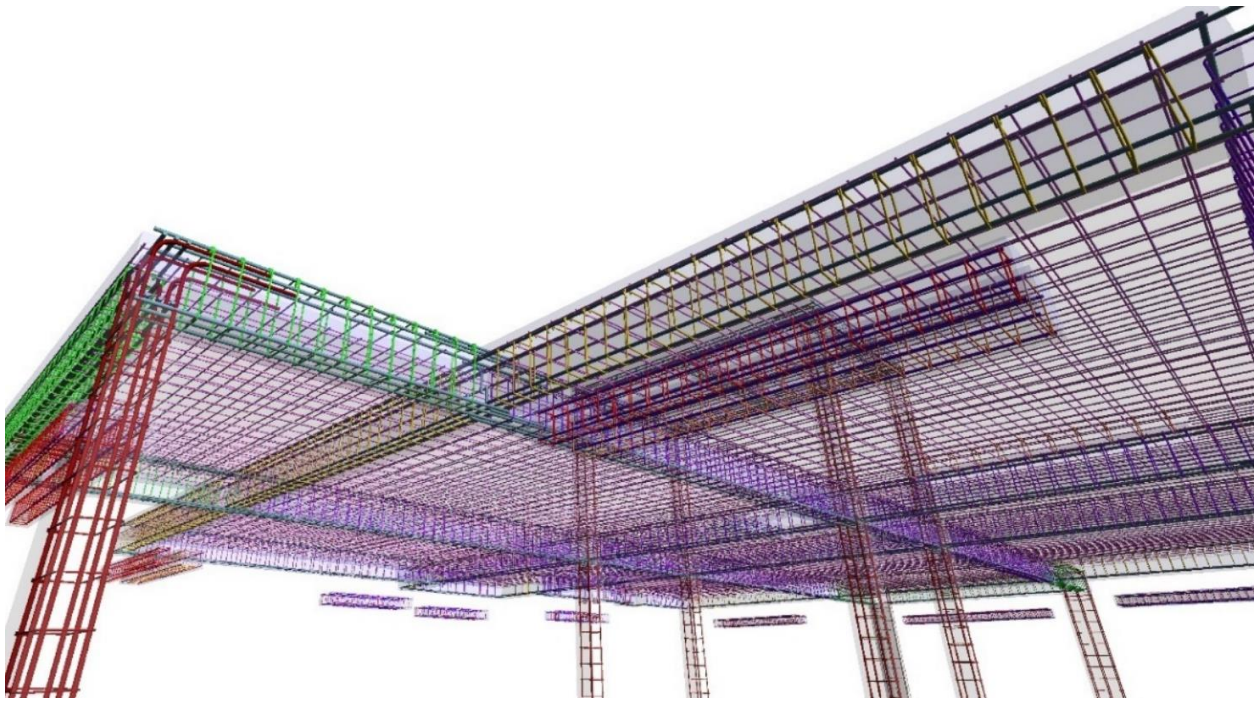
Модель армирования железобетонных конструкций в Autodesk Revit
